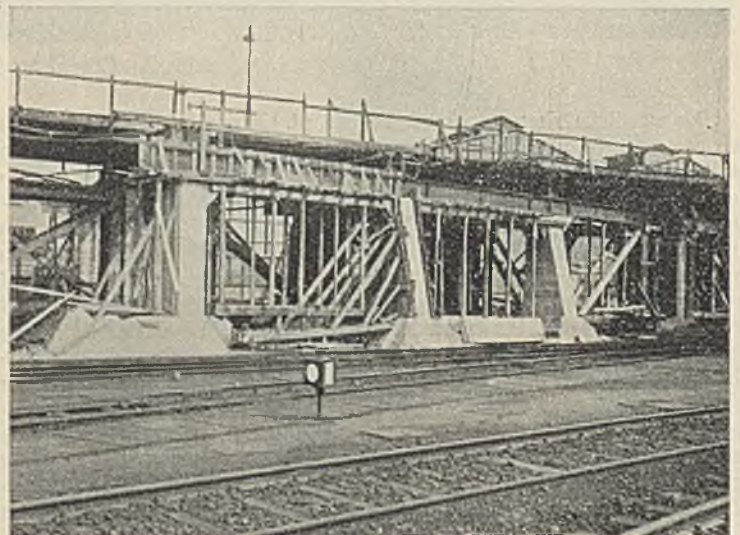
Einbetonierte eiserne Rahmen. Strecke am Stellwerk.
